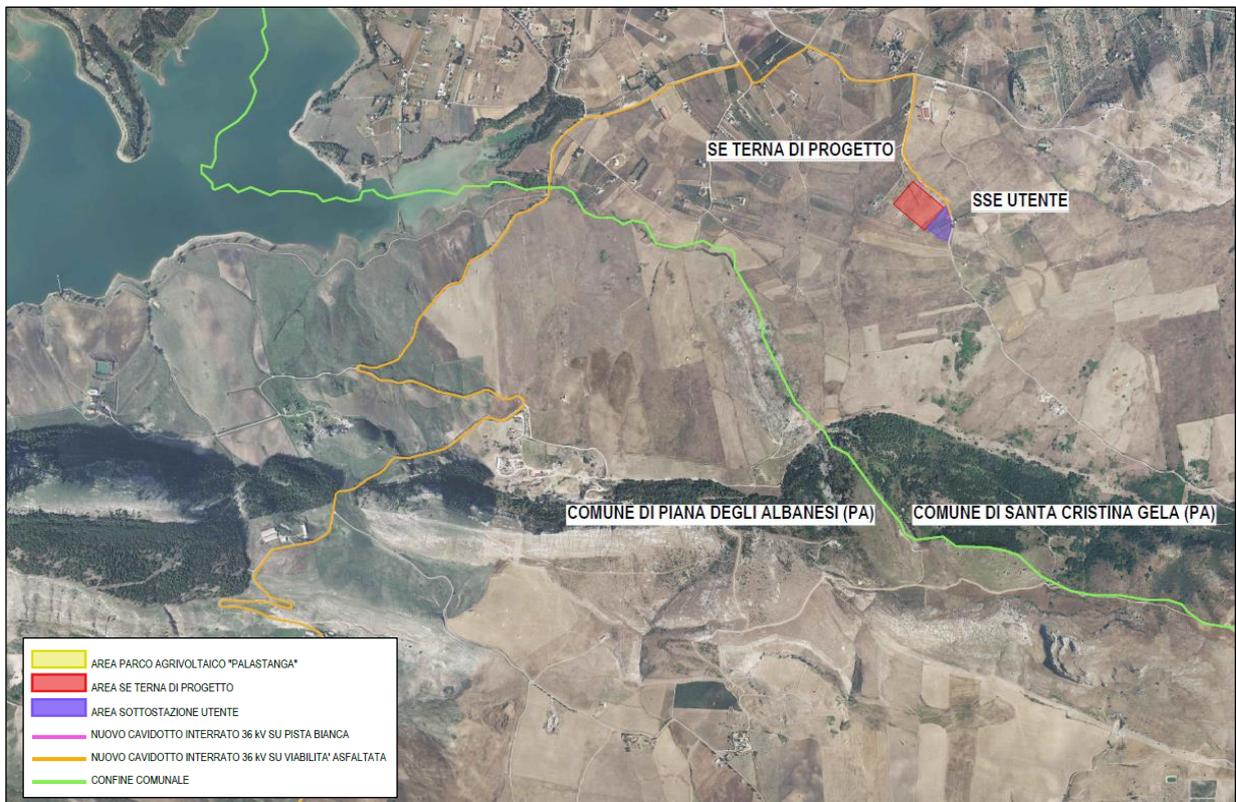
Inquadramento opere in progetto (area stazioni) su Ortofoto (Scala 1:10000)
